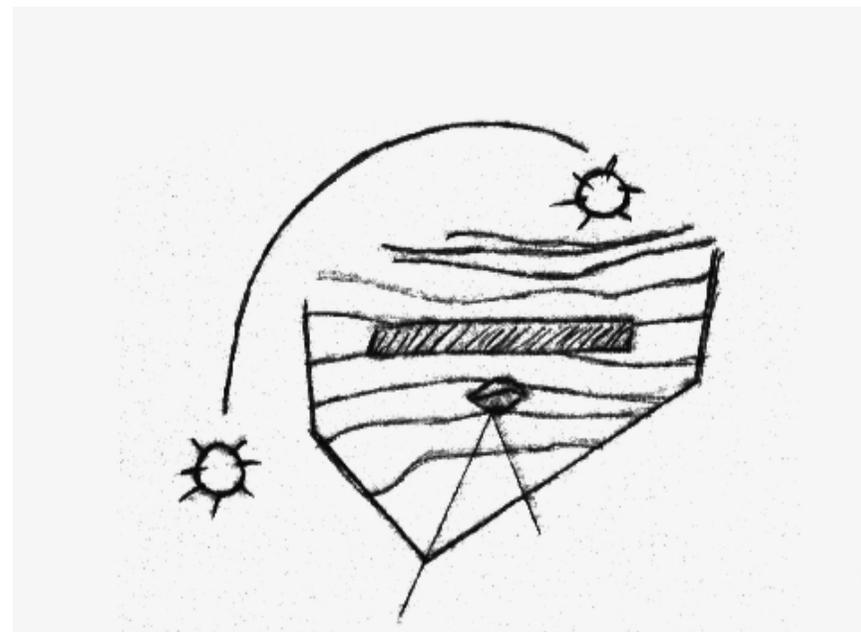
Estudo esquemático em planta da posição do edifício em relação à incidência solar do Hotel de Ouro Preto Fonte: Lauro Cavalcanti
